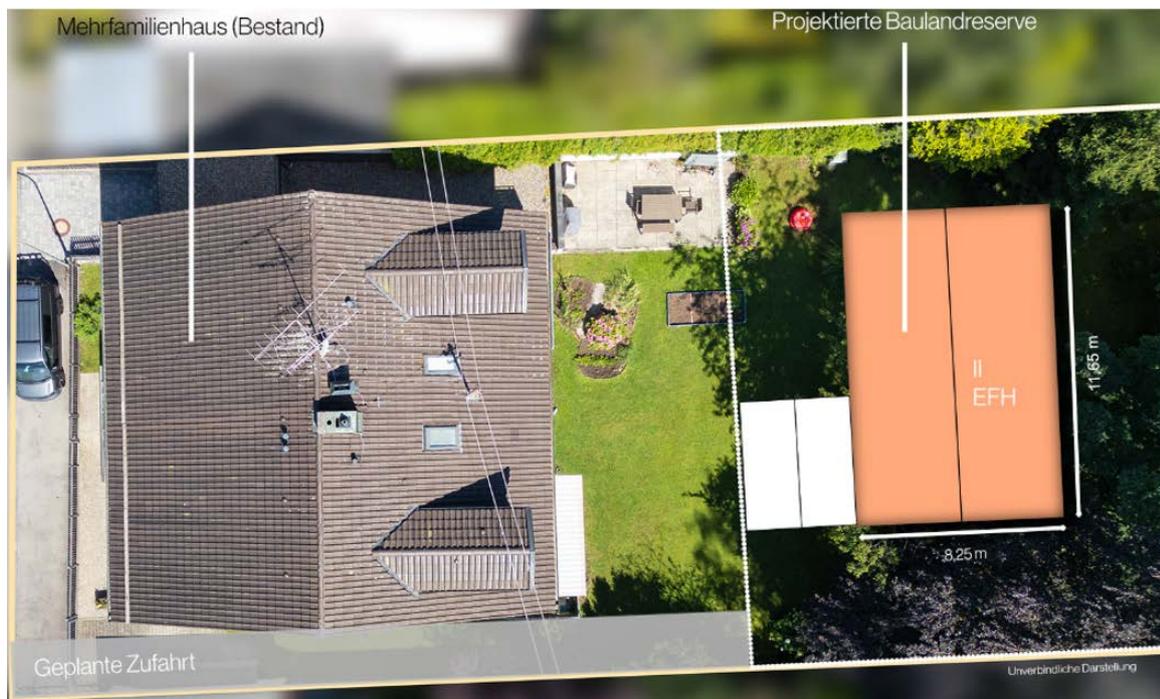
Aufsicht über die vorhandene und geplante Bebauung Mozartstraße 2a (aus dem Bauplan der Eigentümer)
